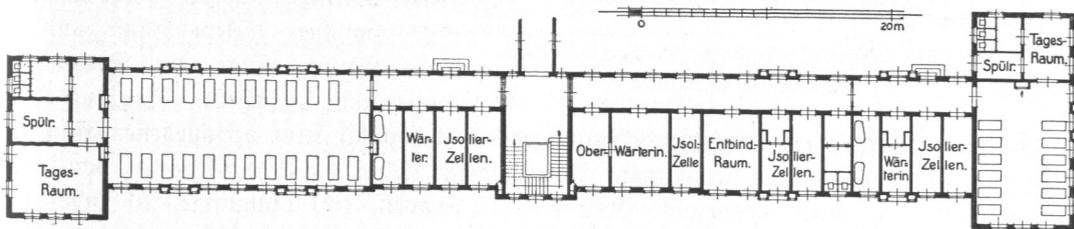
Hafenkrankenhause, Krankenpavillon, Erdgeschoß, Grundriß.
